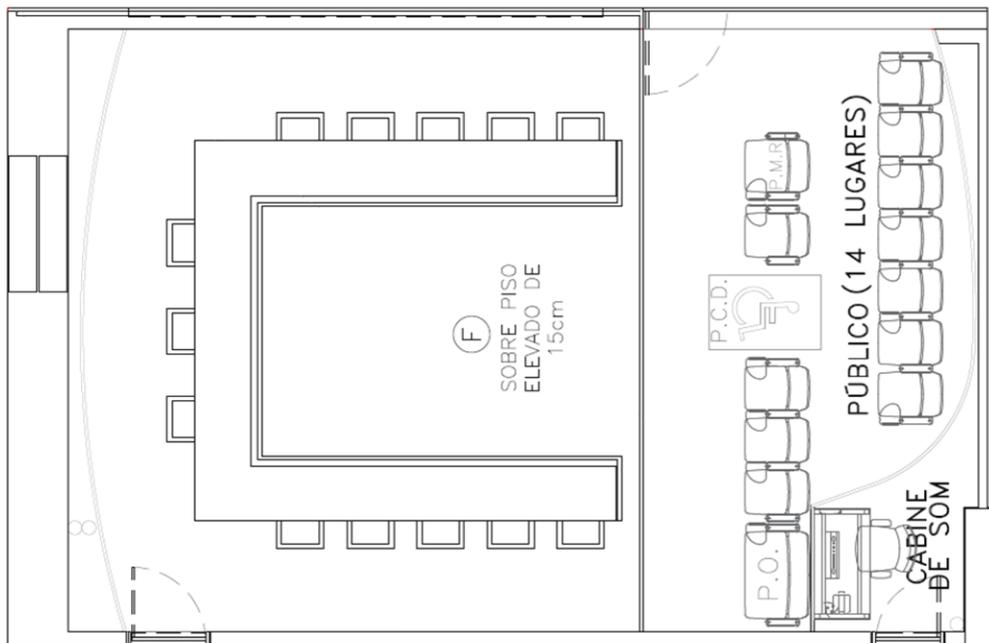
Planta baixa Plenarinho da ALEPE, projeto Pontual Arquitetos.
